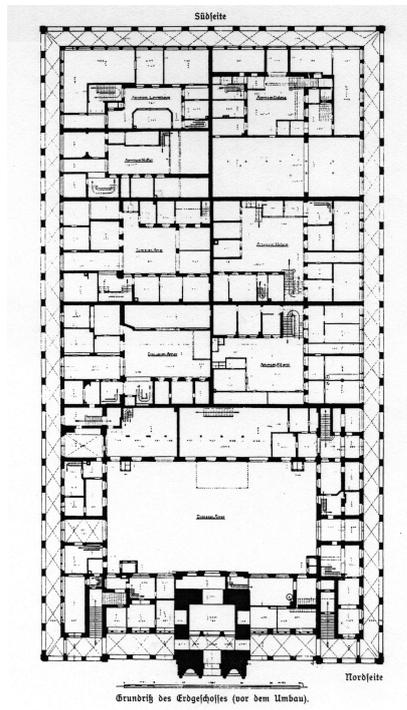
Grundriß des Erdgeschosses vor dem Umbau
